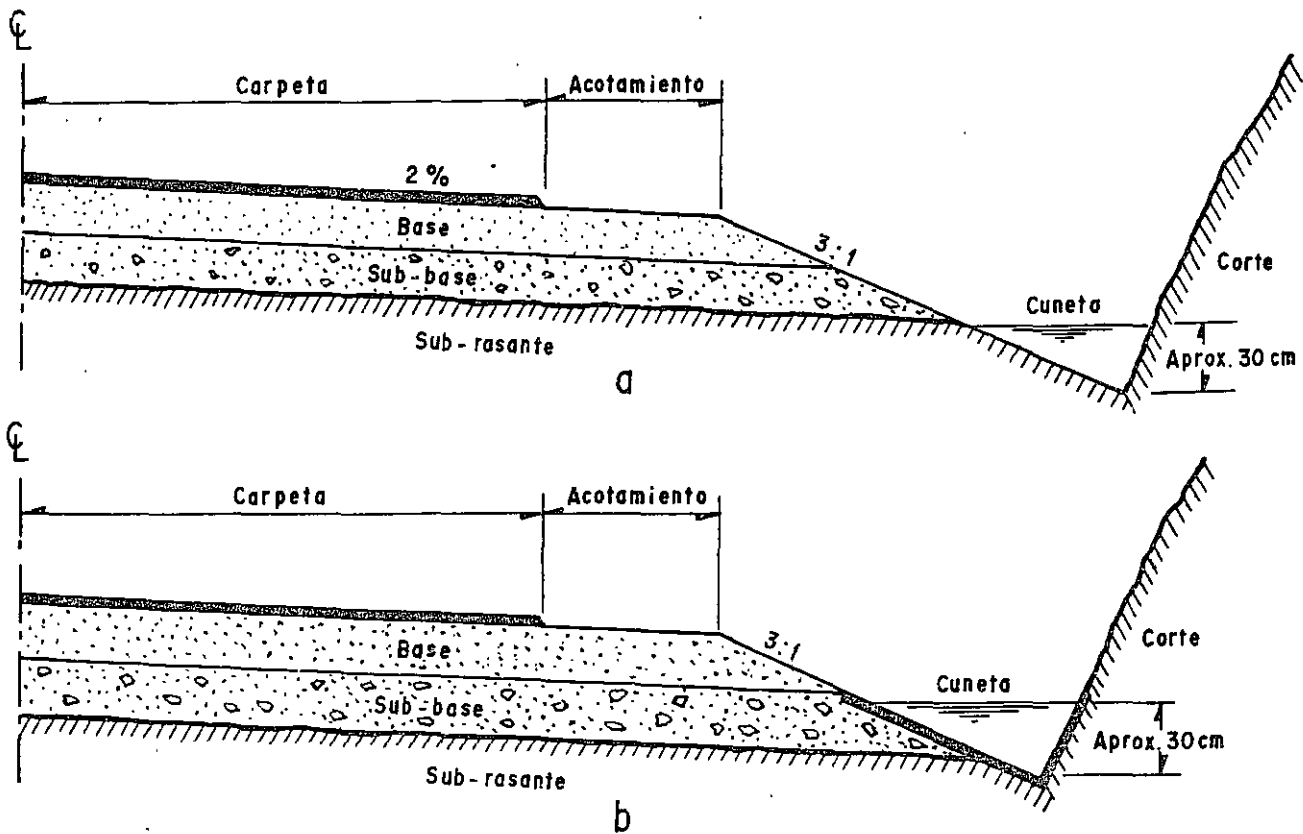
Disposición más conveniente de la cuneta, respecto al pavimento. Sección en corte, sin subdrenaje.
